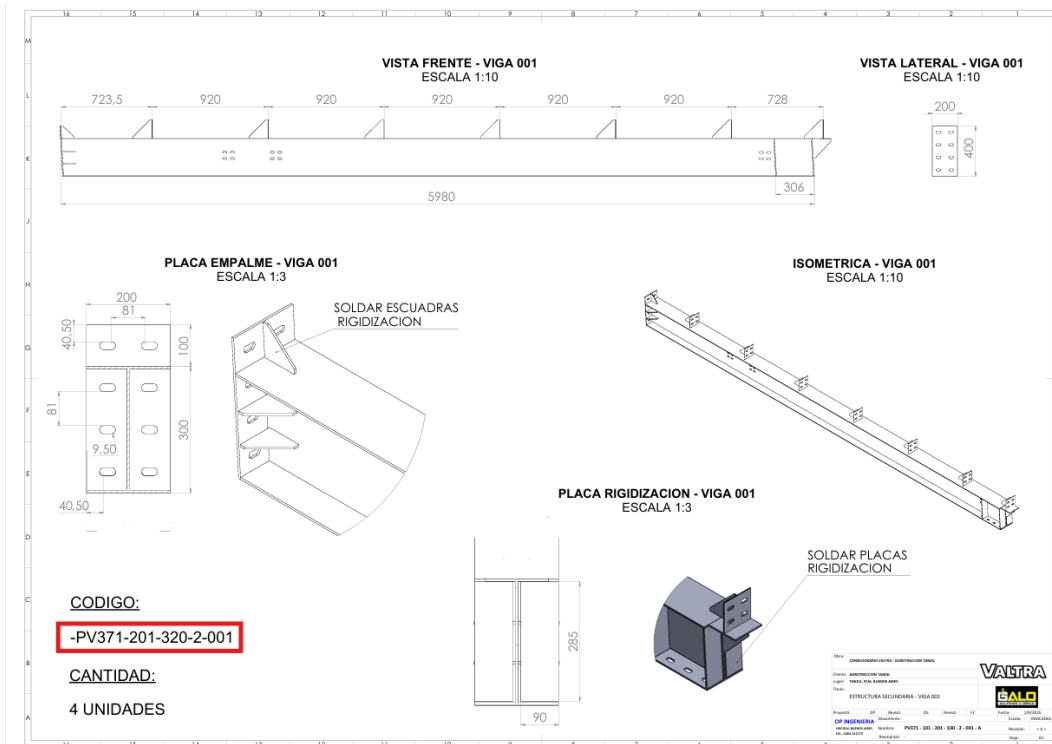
Plano de corte. Fuente: Elaboración propia.
